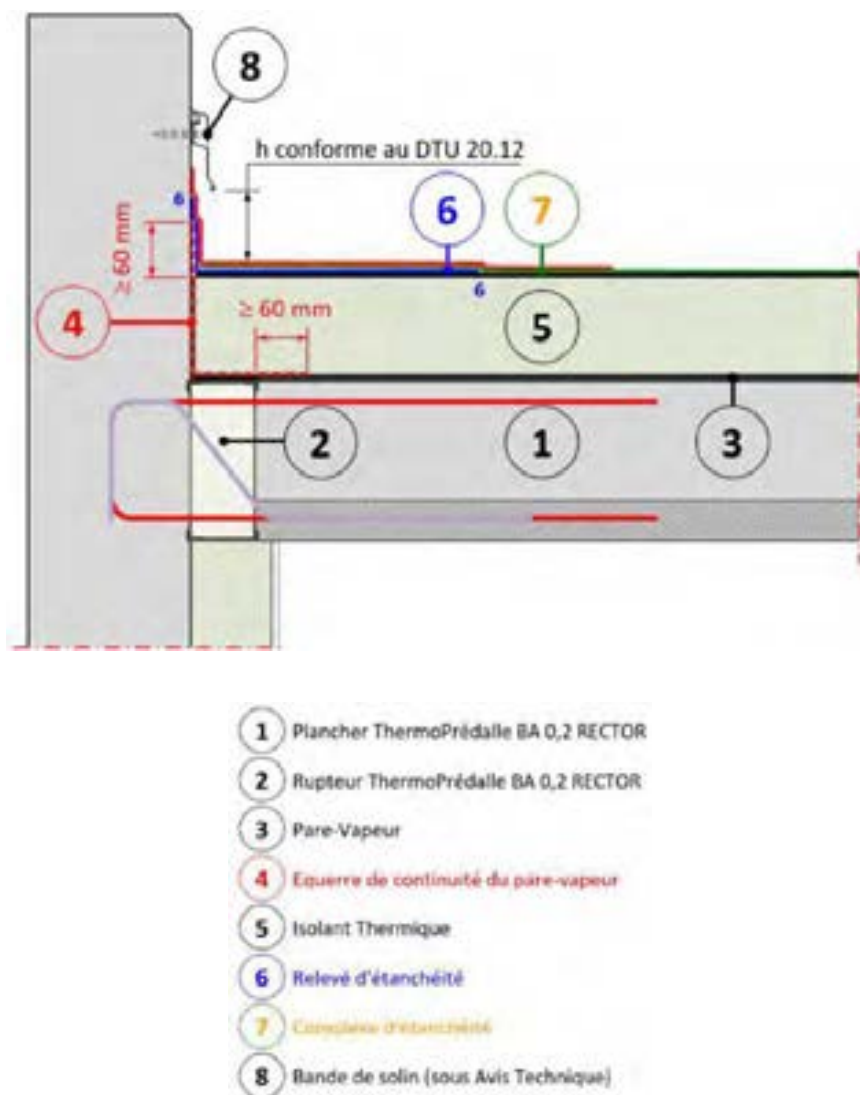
Exemple de disposition de l'étanchéité en toiture terrasse
